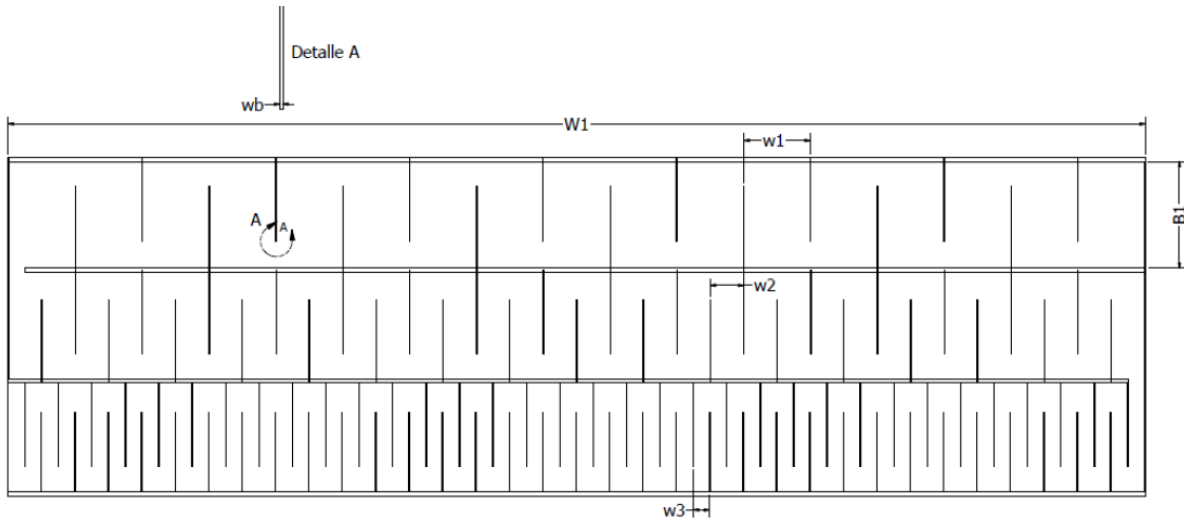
Vista en planta de un floculador hidráulico de flujo horizontal
